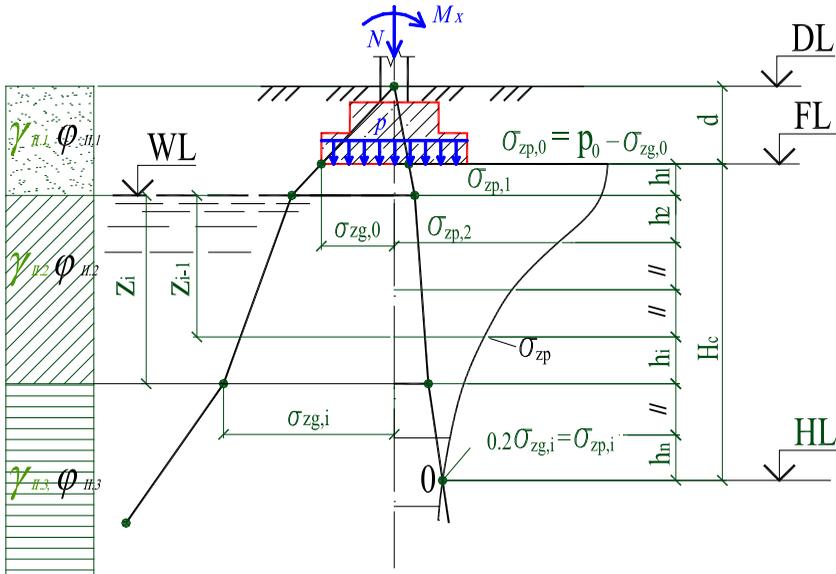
Расчетная схема для определения осадок методом послойного суммирования, совмещенная с геологической колонкой
